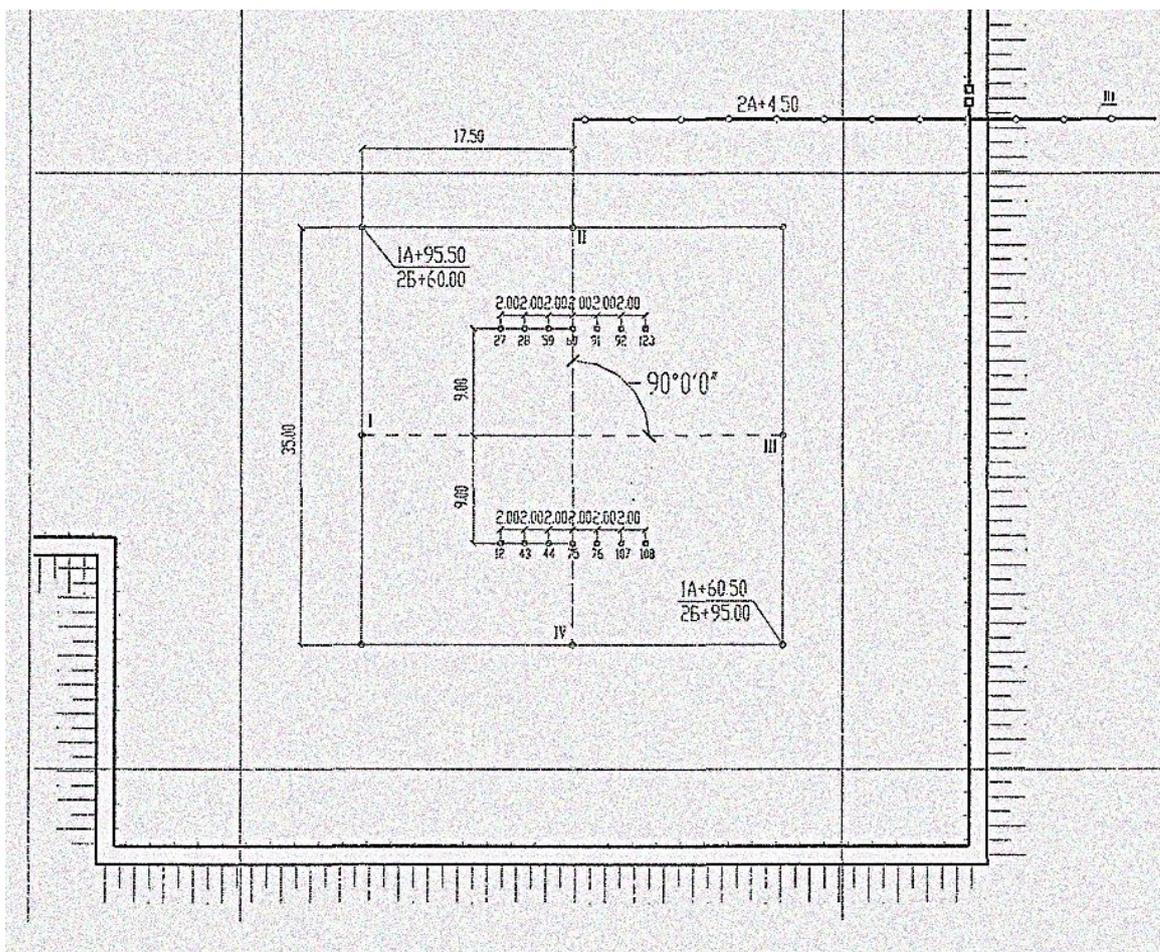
Схема разбивки детальных осей резервуара нефти
